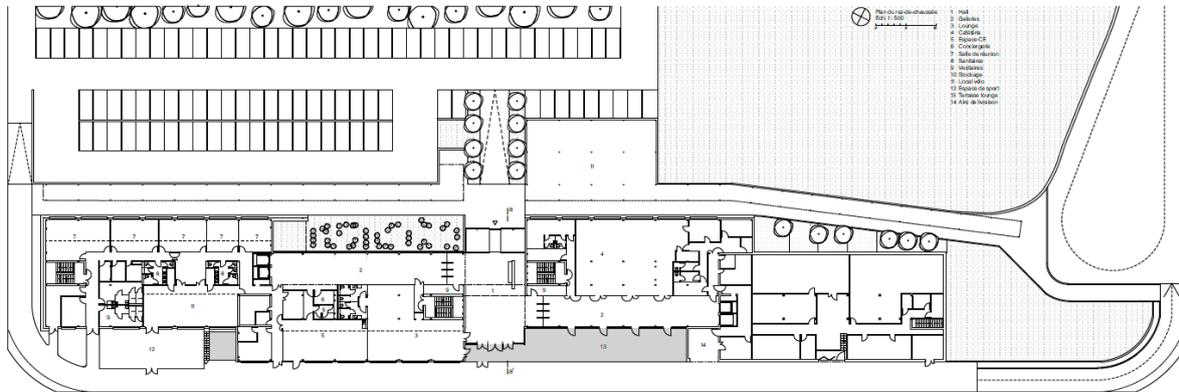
Plan de rez-de-chaussée. ©ArtBuild Architects
